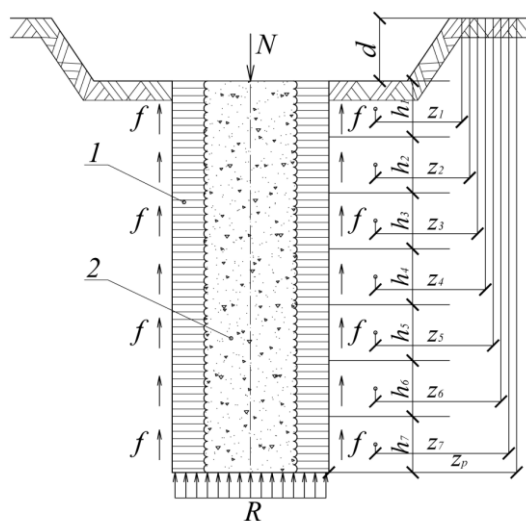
Схема к определению несущей способности сваи SFA (НПШ) совместно с грунтоцементным массивом по грунту (грунтбетонные сваи (ГБС)) 1-грунтоцементный массив, 2 – свая SFA (НПШ).
